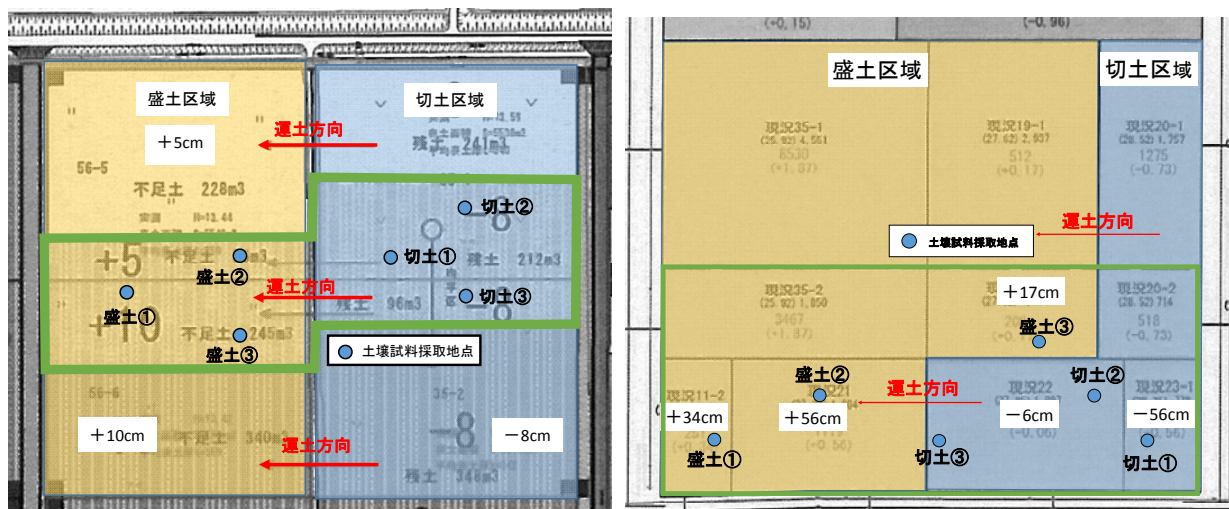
調査圃場の平面図(左:A圃場、右:B圃場) Ground plan of survey field
